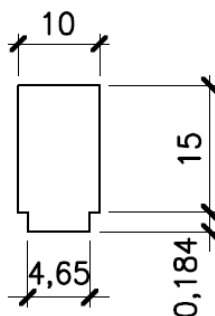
Seção transversal transformada para vigas reforçadas com 1CFJ (dimensões em cm).
